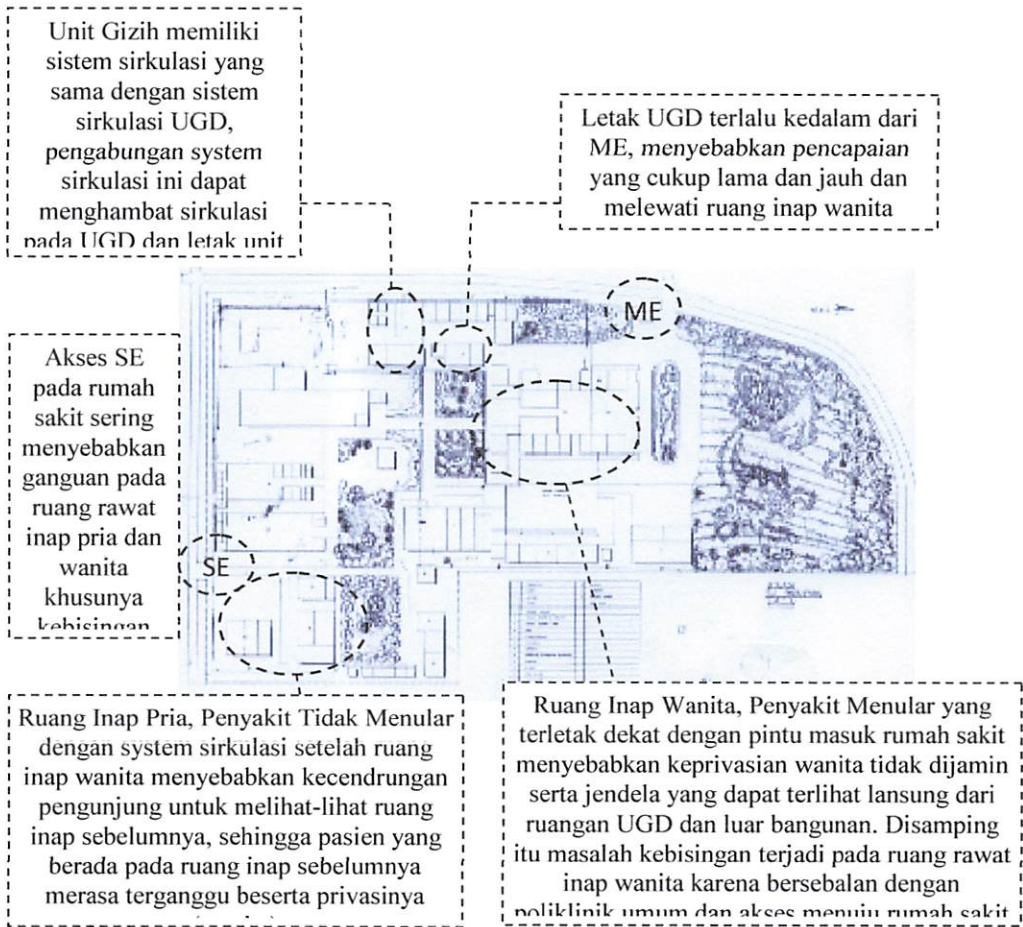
; Denah Rumah Sakit Paru Batu, Malang
